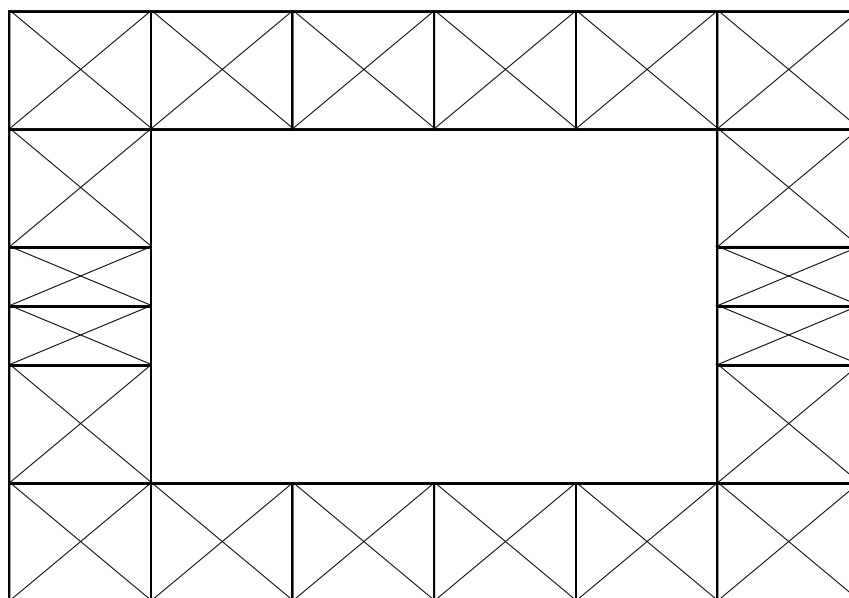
Viga contraviento tipo Pratt de la estructura completa.
